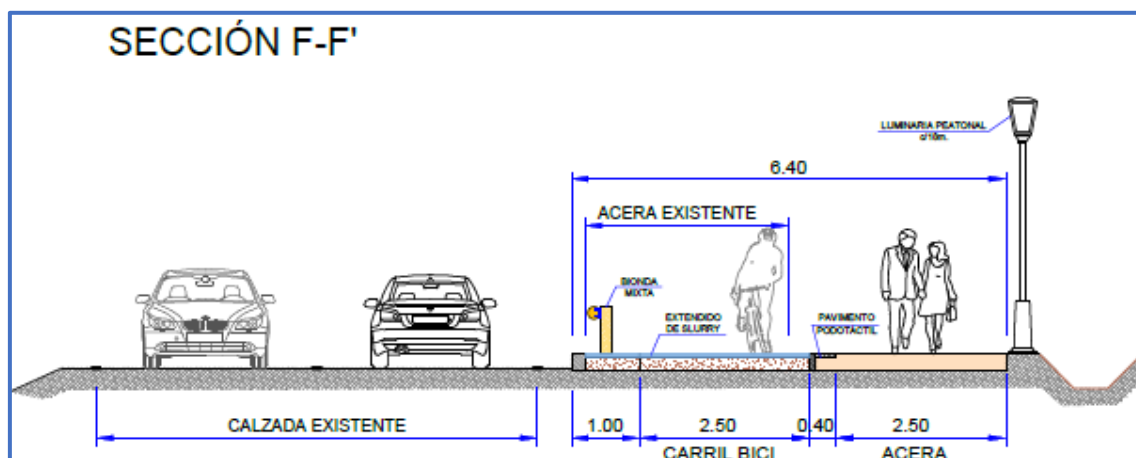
Sección transversal con bionda mixta y conversión de la acera existente en carril bici con ampliación de sección y capa de slurry de color negro.
